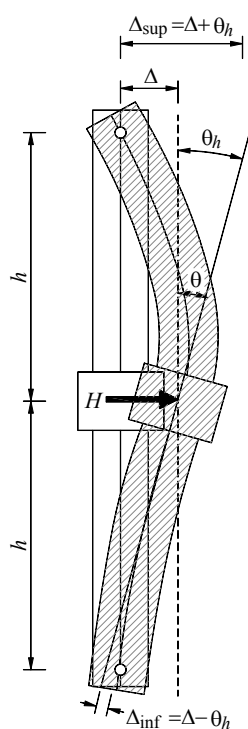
Assimetria nas rótulas plásticas do provete ensaiado (Priestley et al., 1989).
